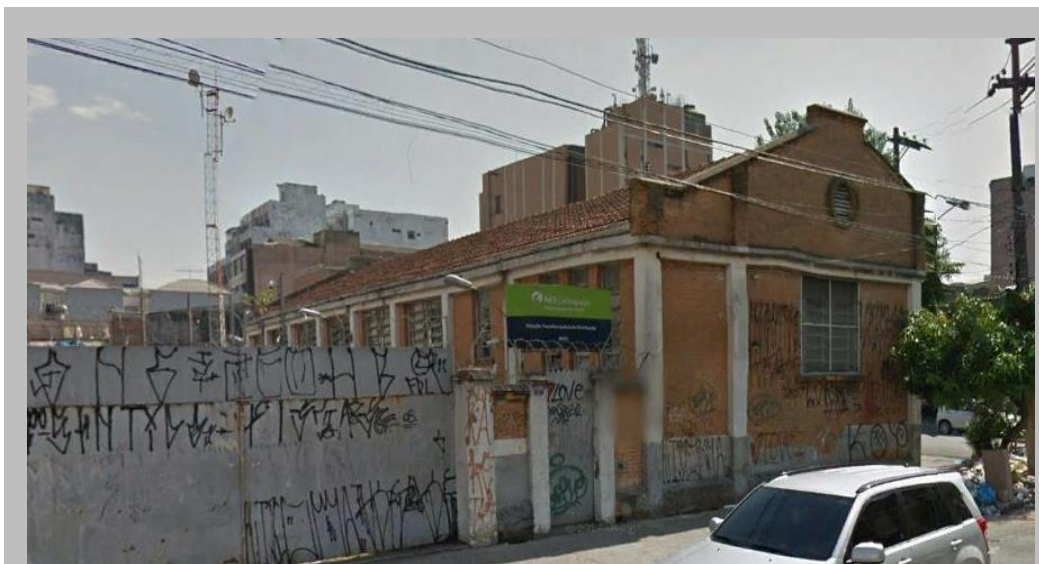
Telhado antes da reforma (Subestação Brás II – Lote II. Imagem Google Earth.
